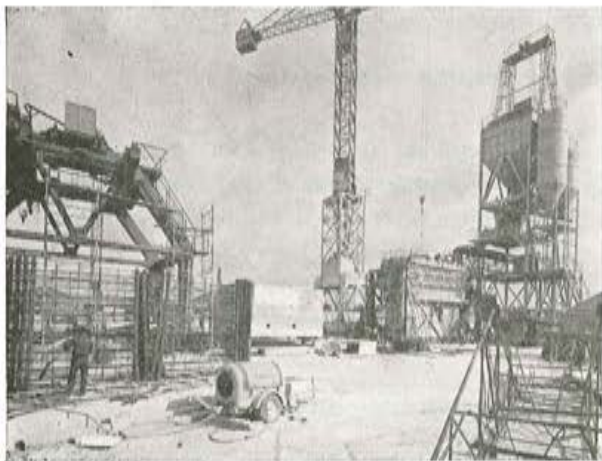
Vista general del taller de prefabricación. Al pie de la central de hormigonado, el molde de las dovelas y su cinta transportadora de alimentación. En primer plano el taller de montaje de las armaduras y vainas.
